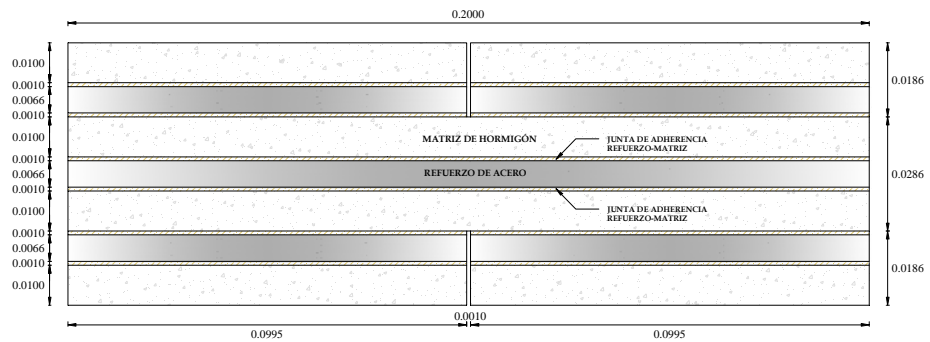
DIMENSIONES DE LA PIEZA DE HORMIGÓN ARMADO
